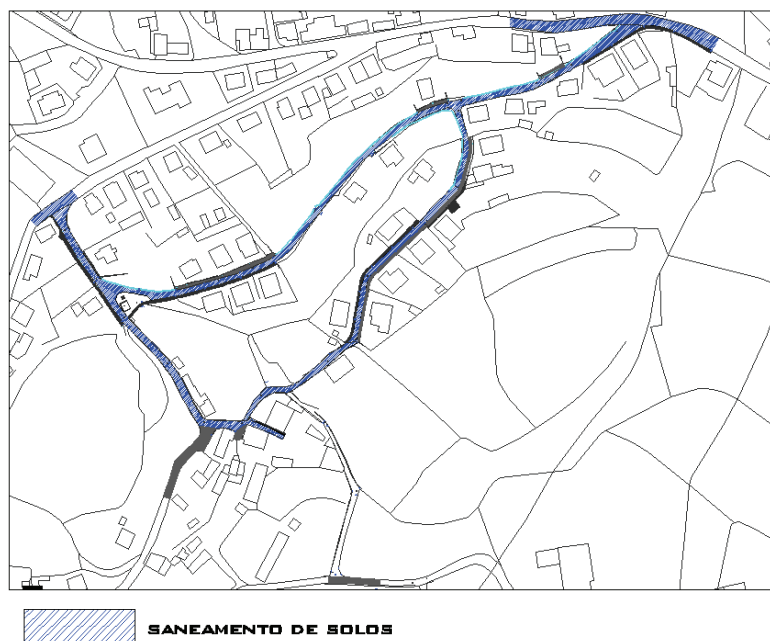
Trabalhos de pavimentação na Rua das Agrads, Travessa das Agrads e Rua do Combro.
